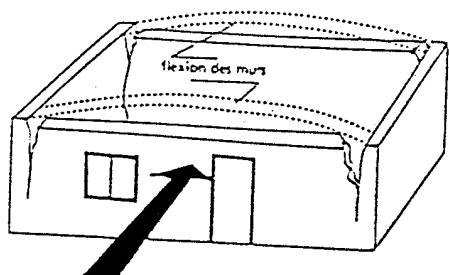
Fissuration verticale aux angles (Zacek, 1996)
